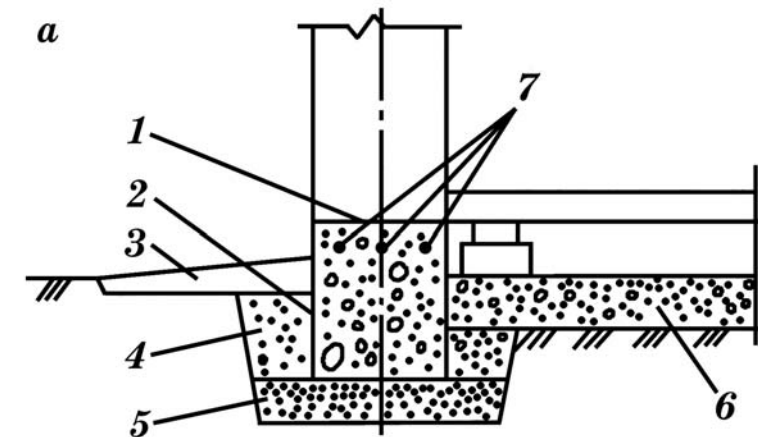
Ленточные фундаменты из бутобетона и монолитного бетона:
